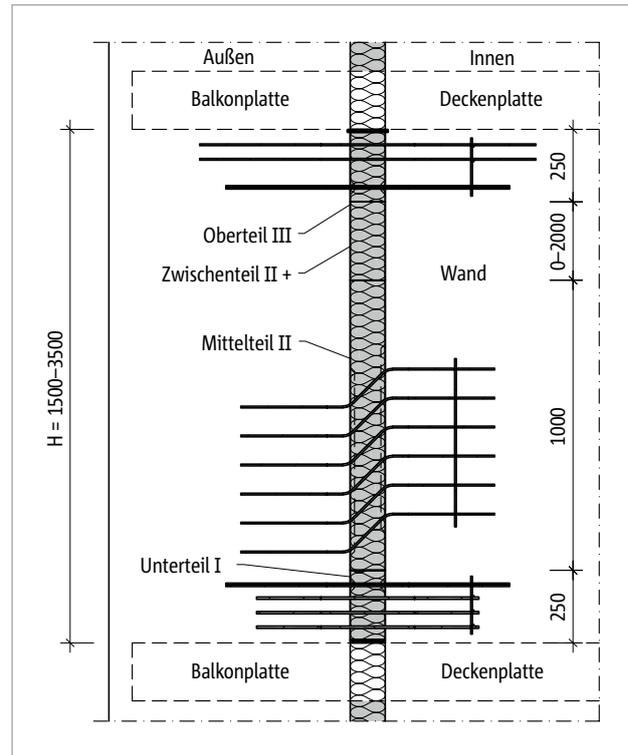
Schöck Isokorb® XT Typ W: Balkonkonstruktion mit wärmeisolierten tragenden Wandscheiben
